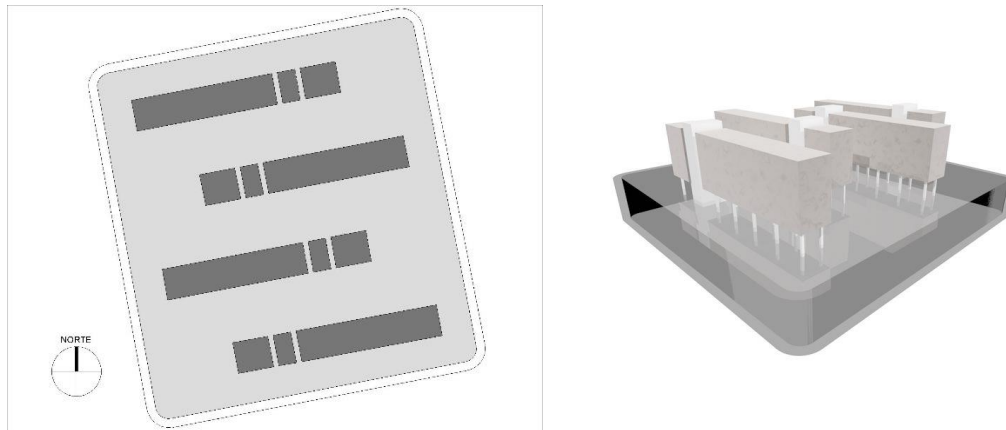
Implantación en S doble ortogonal a norte. Planta - isométrico. Elaboración propia.
